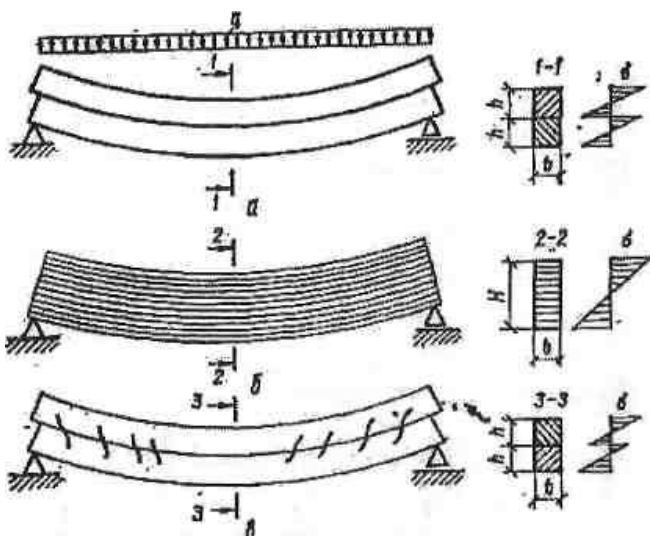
Балки складеного перерізу: а – пакет із двох дощок; б – клеєна на жорстких в'язях (монолітна); в – на піддатливих в'язях
